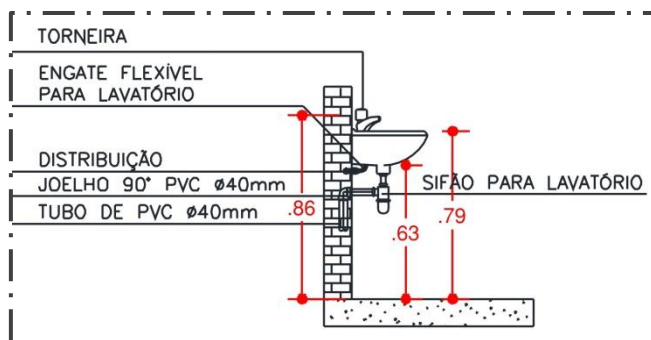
Planta baixa do lavatório dos banheiros do apartamento de padrão popular
